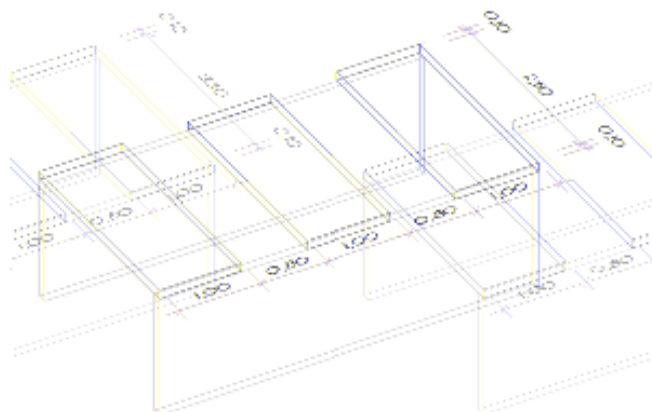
Perspectiva esquemática da construção dos protótipos das lajes
